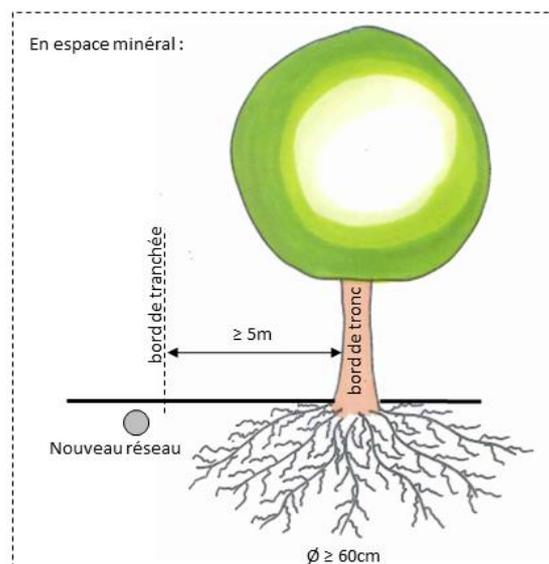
SCHÉMA D'IMPLANTATION D'UN NOUVEAU RÉSEAU EN ESPACE MINÉRAL À PROXIMITÉ D'UN ARBRE EXISTANT D'UN DIAMÈTRE ≥ 60 CM
